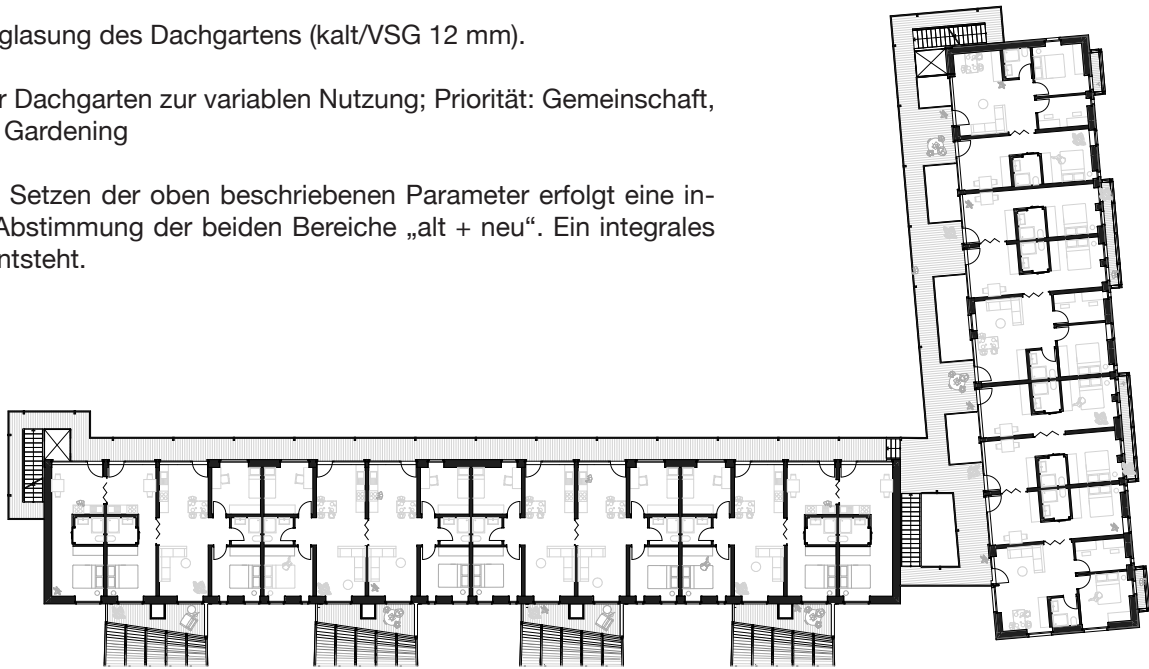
Grundriss Aufstockung | M 1:500
